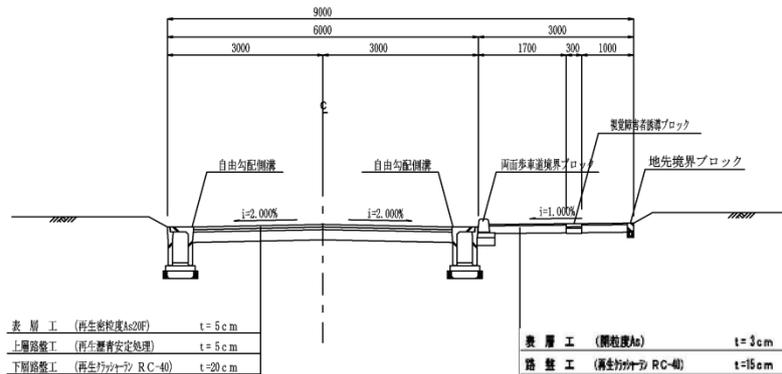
(5) 道路断面図(主要区画道路:9m 標準断面)
